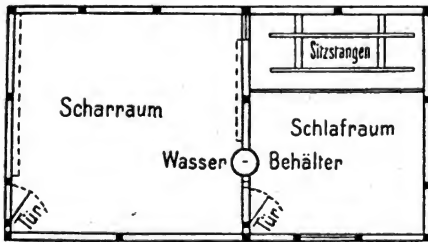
Grundriss eines Hühnerstalles.
